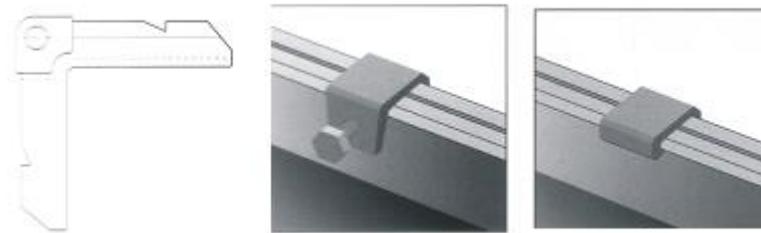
Элементы соединения прямоугольных воздуховодов, аналог фланцевому (угольник, стяжка накладок струбциной, установленная монтажная скоба)
